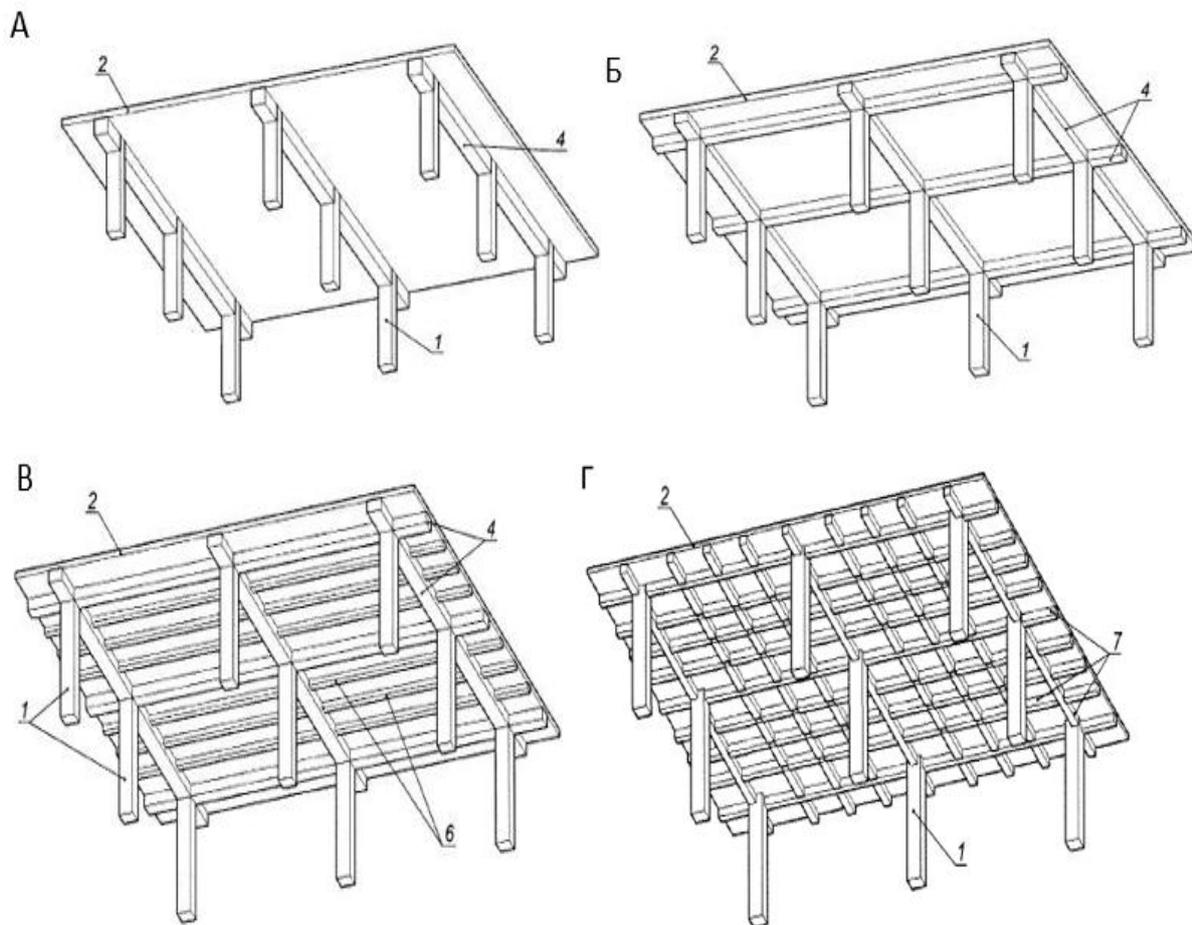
Плиты балочных перекрытий в монолитных конструктивных системах:
